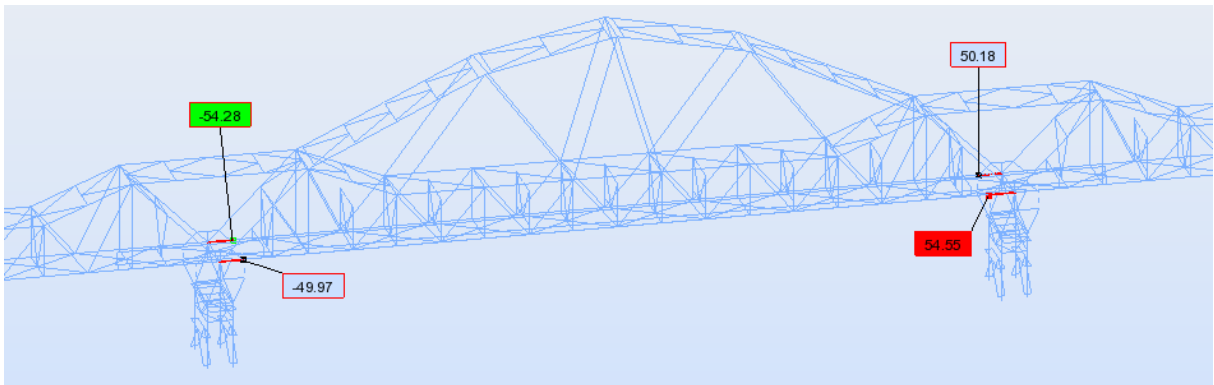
Esforço transverso nos elementos de apoio (após betonagem)
